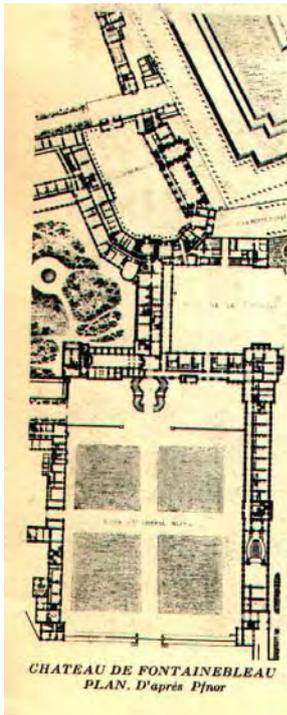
Castelo de Fontainebleau – Planta Baixa
